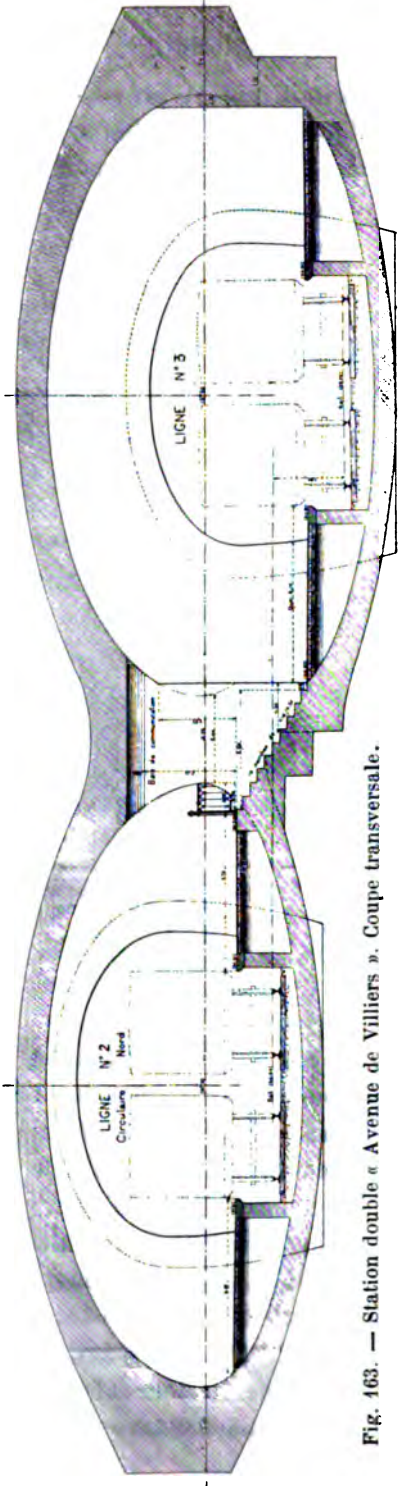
Station double « Avenue de Villiers ». Coupe transversale.
